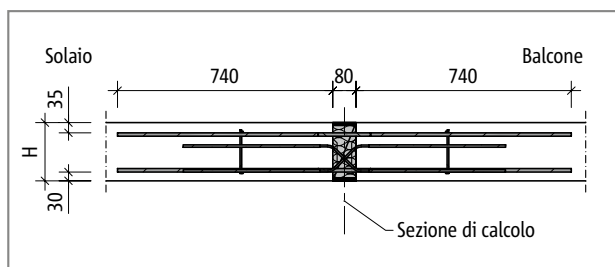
Schöck Isokorb® T tipo DL-CV1: schema statico
